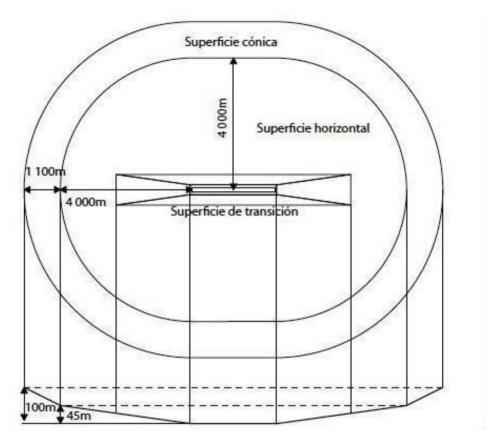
Vista en planta y de perfil de las superficies de transición, horizontal interna y cónica. Fuente: UNAM.
